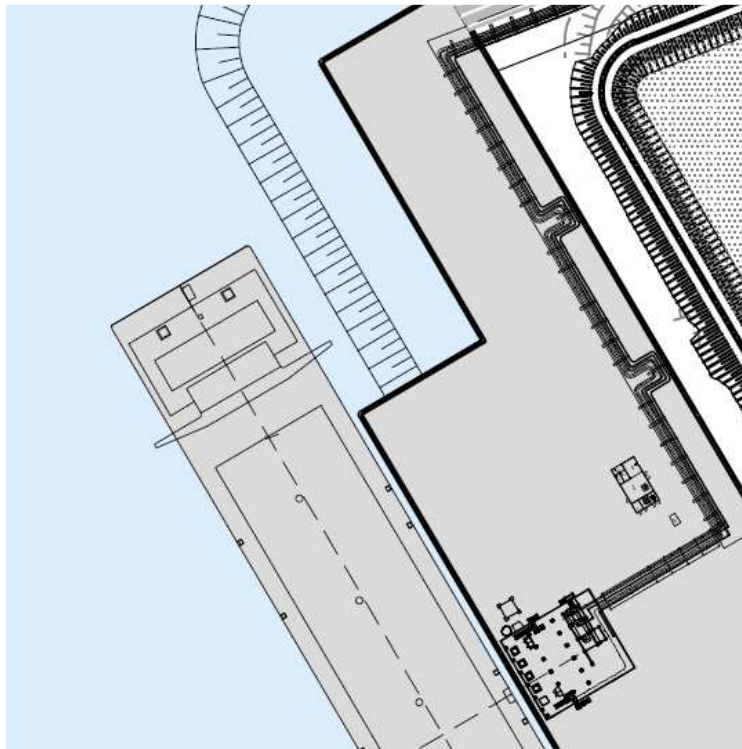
Area 1 – Struttura a supporto equipment banchina
